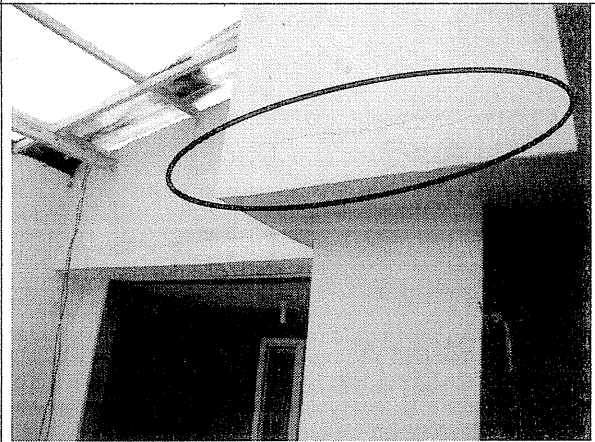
Fisuras en la junta muro placa de cubierta.
